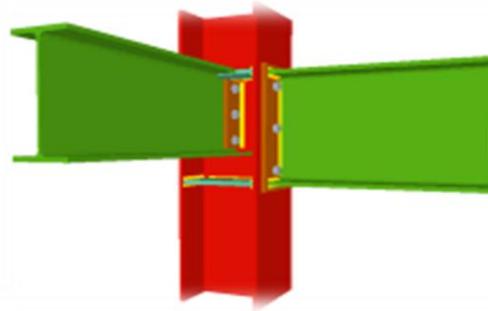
Assemblage soudé d'une poutre encastrée à l'âme du poteau et d'une autre à une aile du poteau en profilé I
